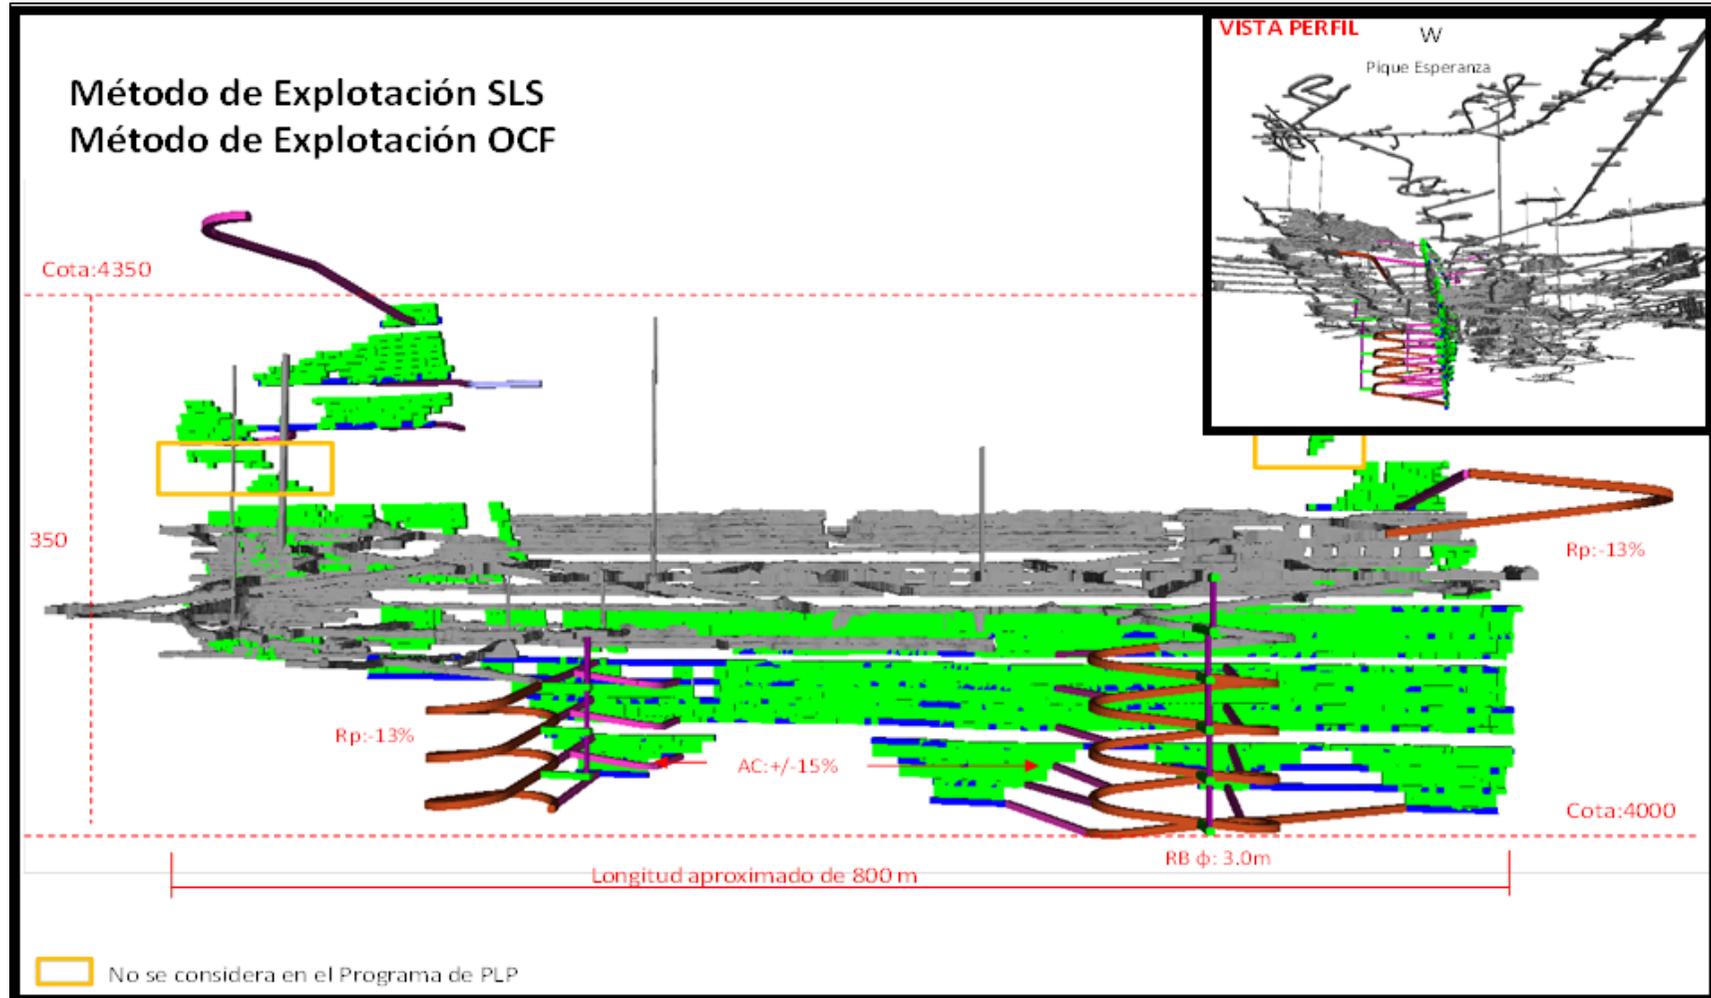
Infraestructura Veta Ramal piso 3 perfil longitudinal- Planeamiento Animon.
